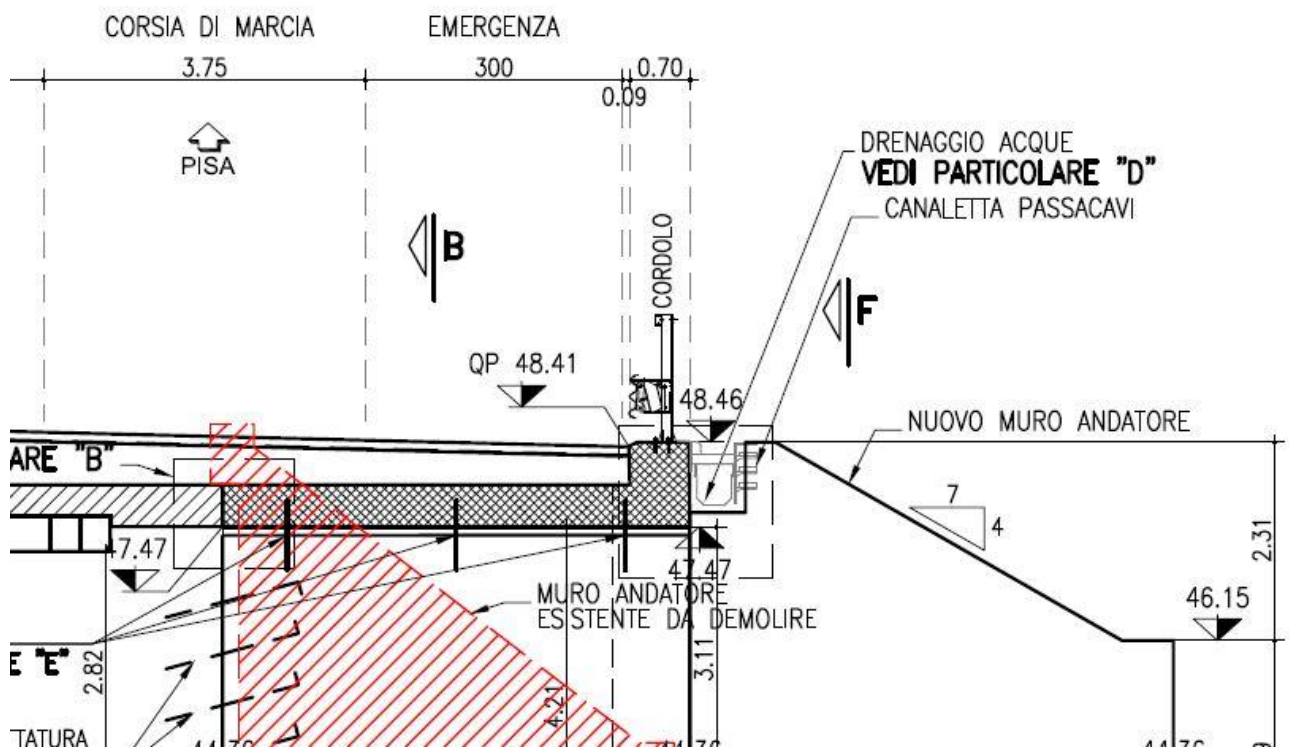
Sezione tipo struttura ampliamento sottovia.
